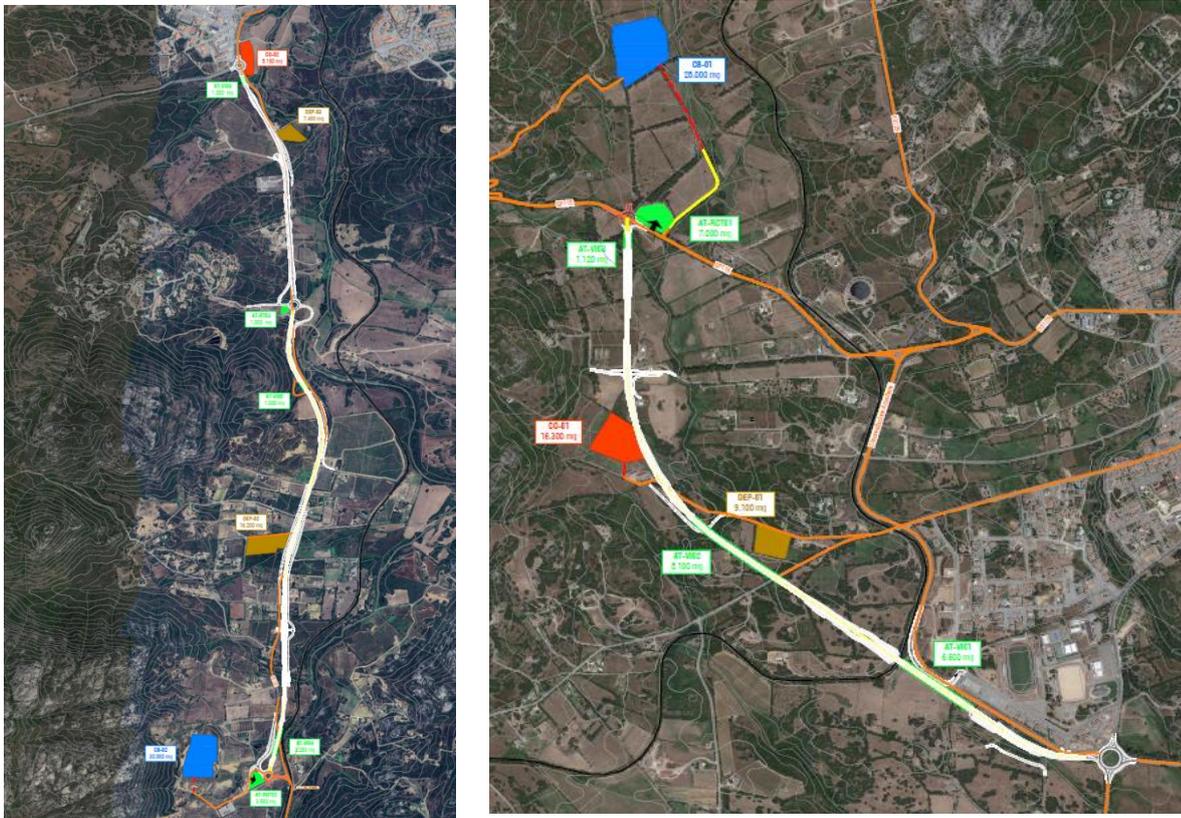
Localizzazione delle aree di cantiere rispetto il tracciato di progetto
